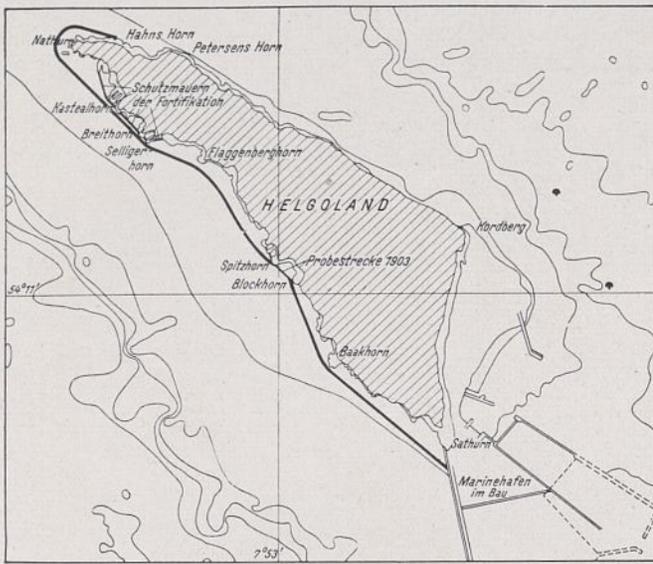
Lageplan der Schutzmauer nach dem Entwurf von 1909.
